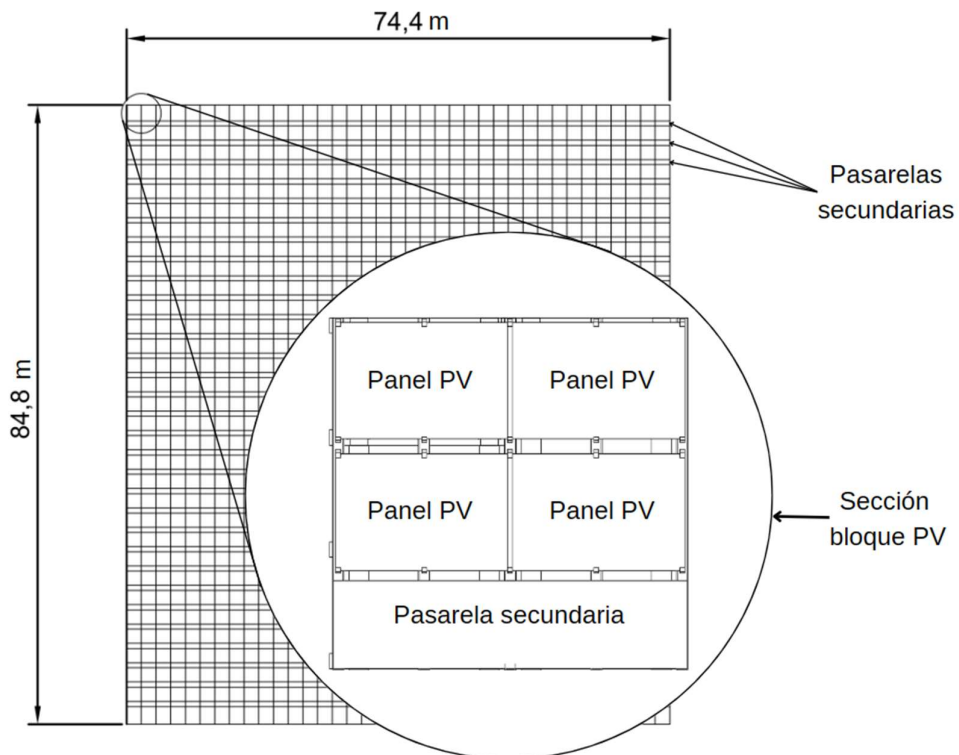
Bloque de paneles fotovoltaicos (estructuras 4 y 8).
